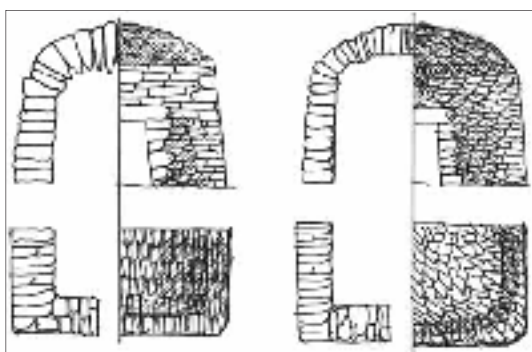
Construcciones de planta cuadrangular con cerramiento de bóveda.
